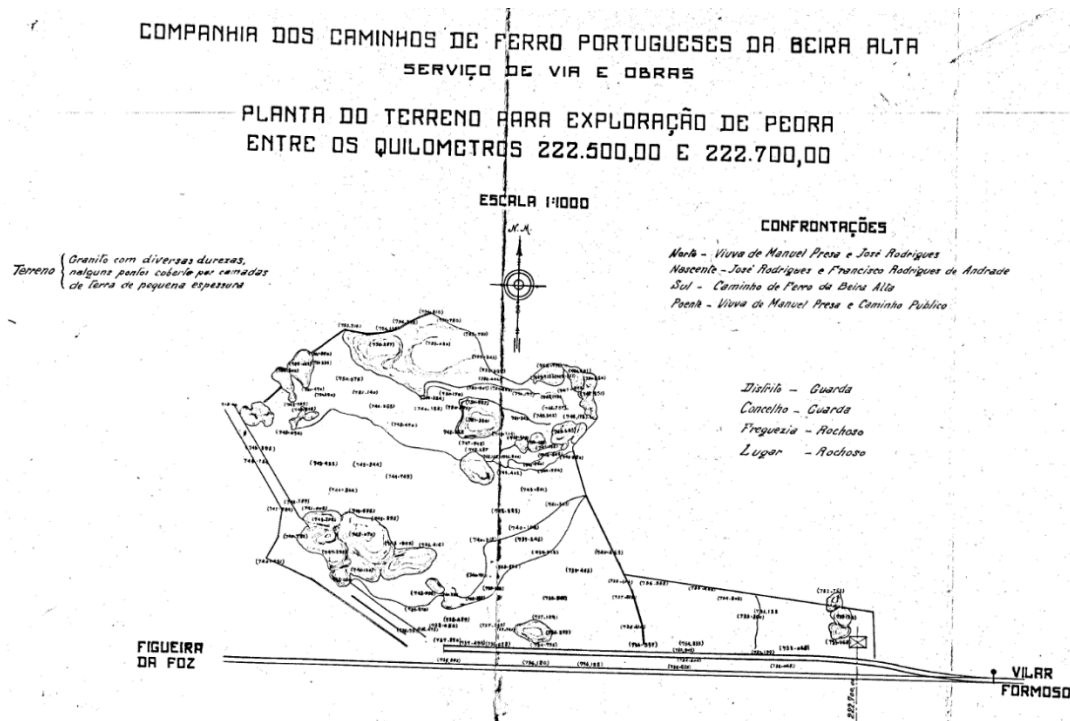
Planta do terreno para exploração da pedra de granito para construção das alvenarias (REFER, 1944)
